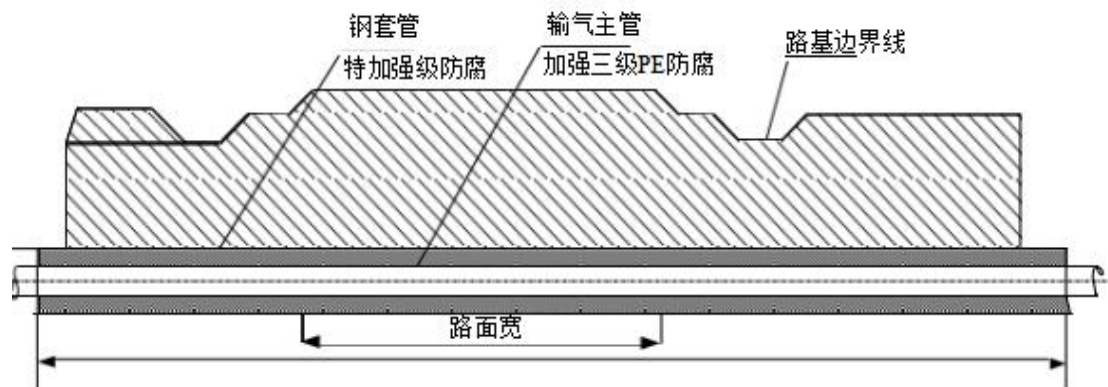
乡村水泥道路穿越施工方式断面示意图
